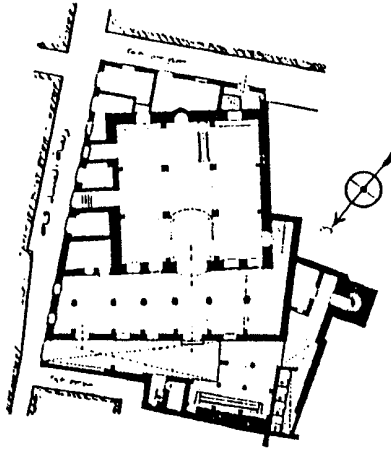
مسقط أفقي لمشهد آل طباطبا بعين الصيرة جنوب القاهرة
